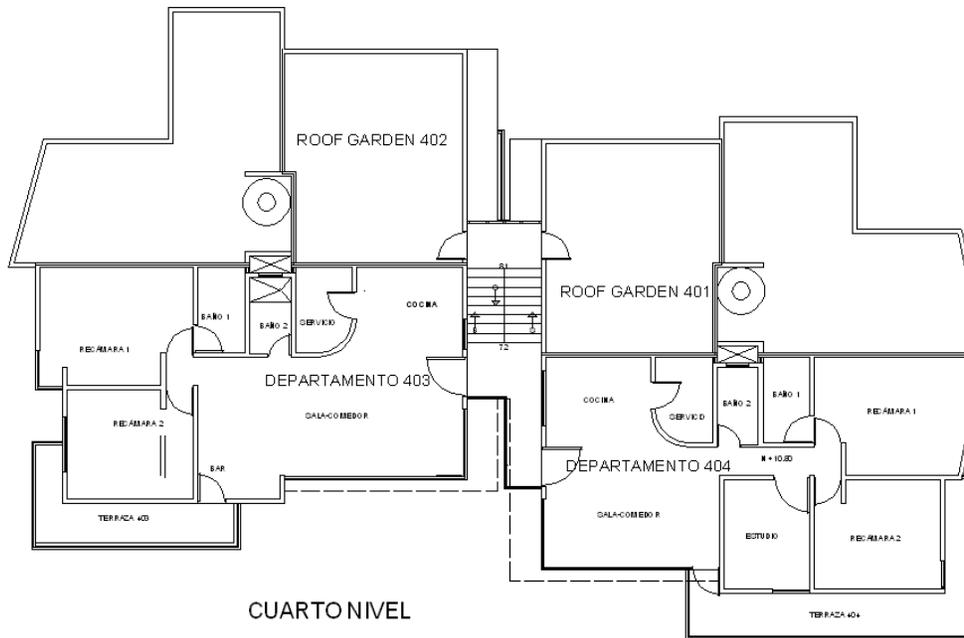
Planta Arquitectónica; Cuarto Nivel
